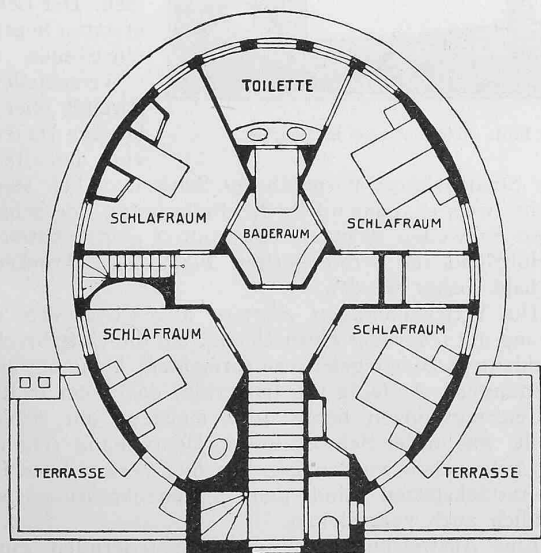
Grundriss vom Obergeschoss des Landhaus-Entwurfs von Prof. Behrens. — Masstab 1:200.
